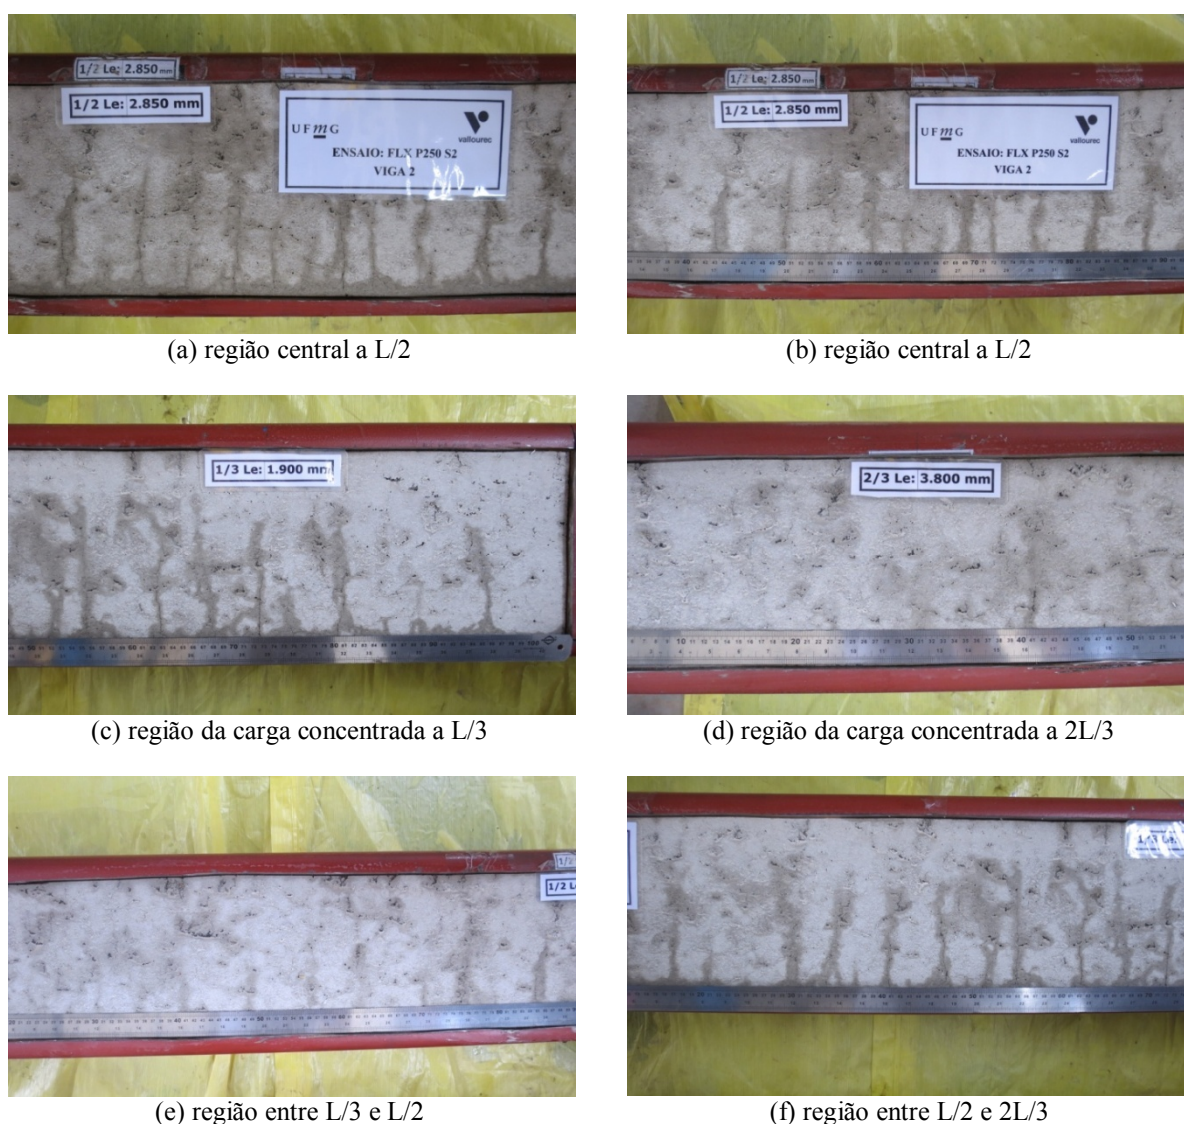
Ensaio de flexão: fissuração do núcleo do protótipo FLX-VM-SL-ST-2
